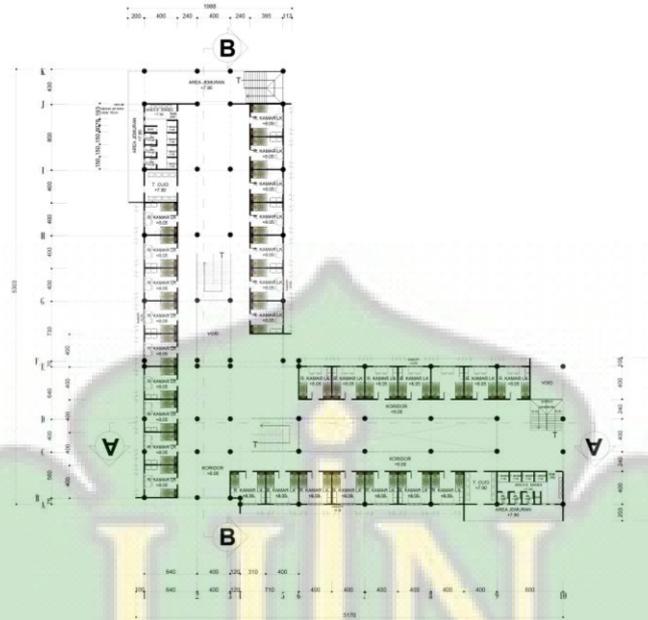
6 Denah Asrama Laki-laki Lantai 1
